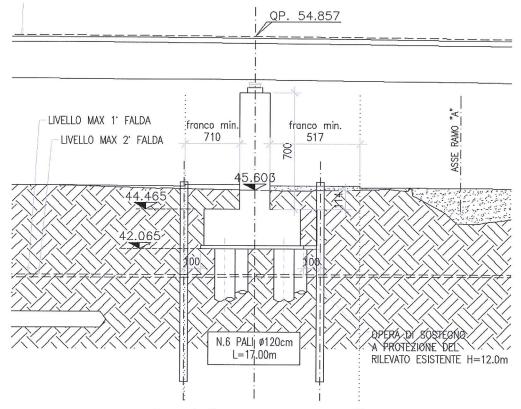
SEZIONE LONGITUDINALE PILA P2
